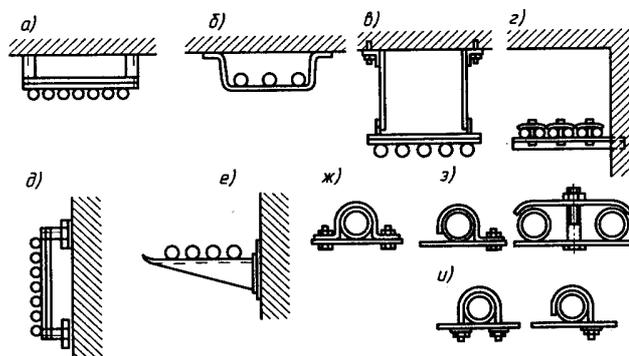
Опорные и крепежные конструкции и детали для трубных электропроводок:
